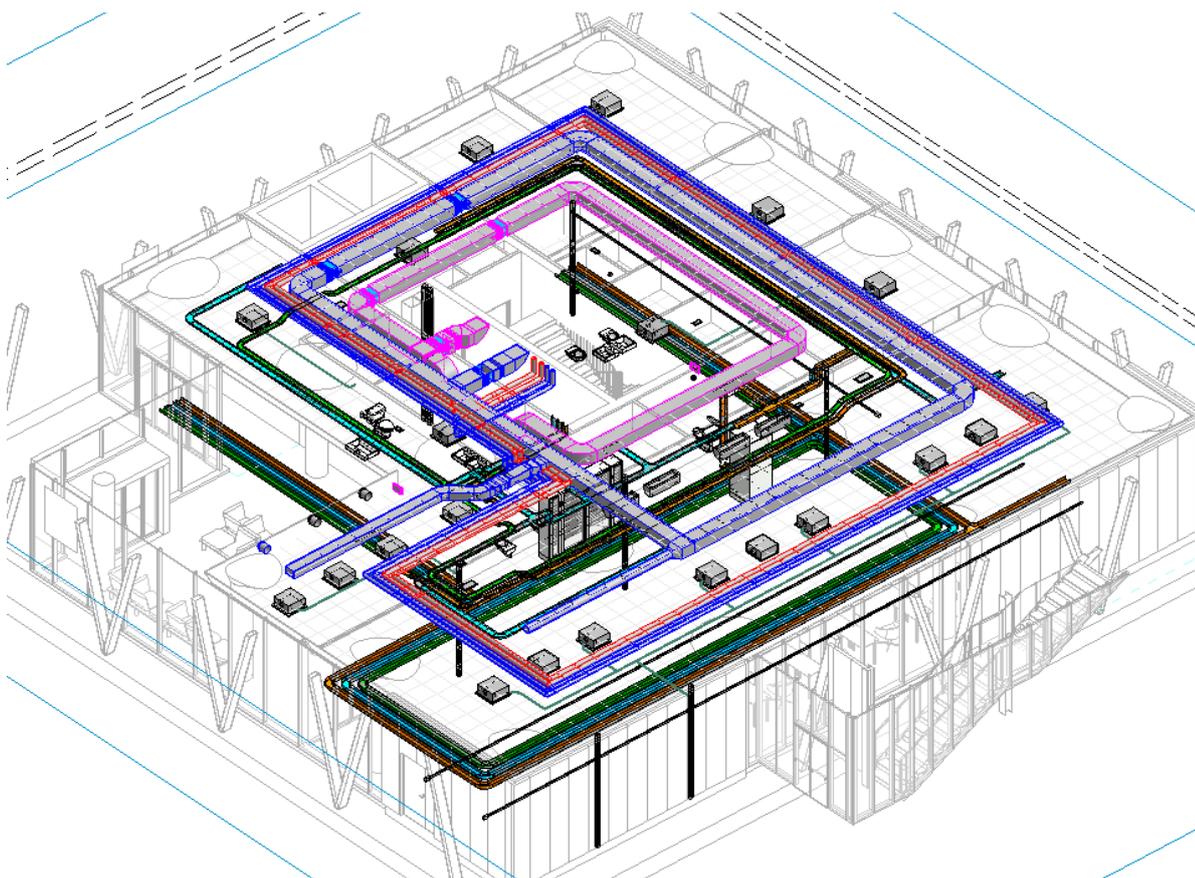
Impianto di distribuzione a soffitto e pavimento coordinato
